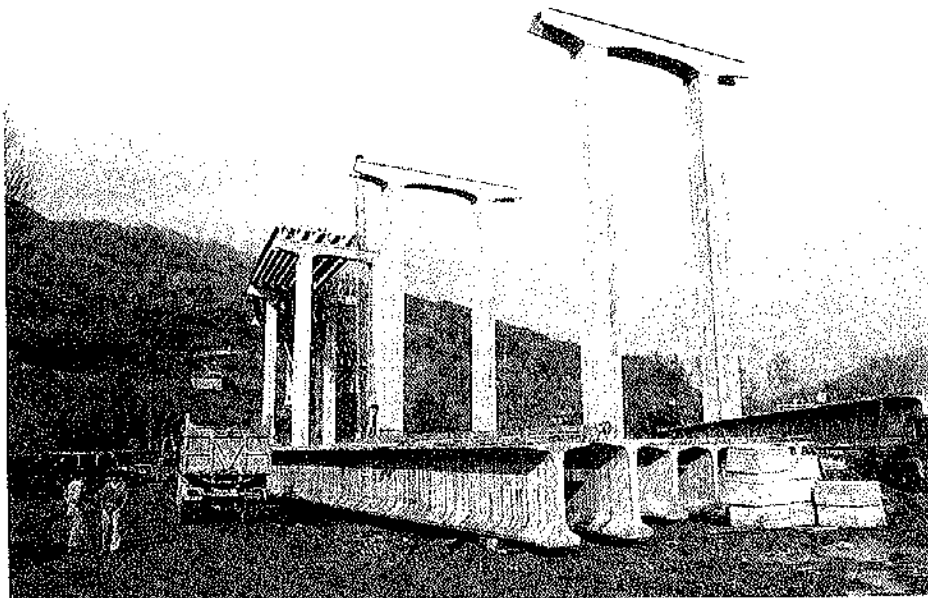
Pilas del viaducto de Huerna, prefabricadas en 1982. El tablero está formado por 13 tramos de 40 m de luz y 22 m de anchura.
